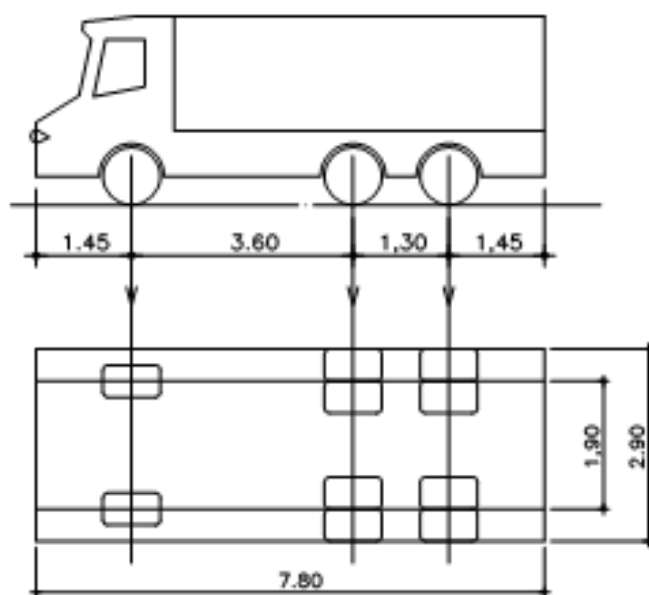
Dimensões do caminhão utilizado como estrutura de reação nos ensaios de placa
